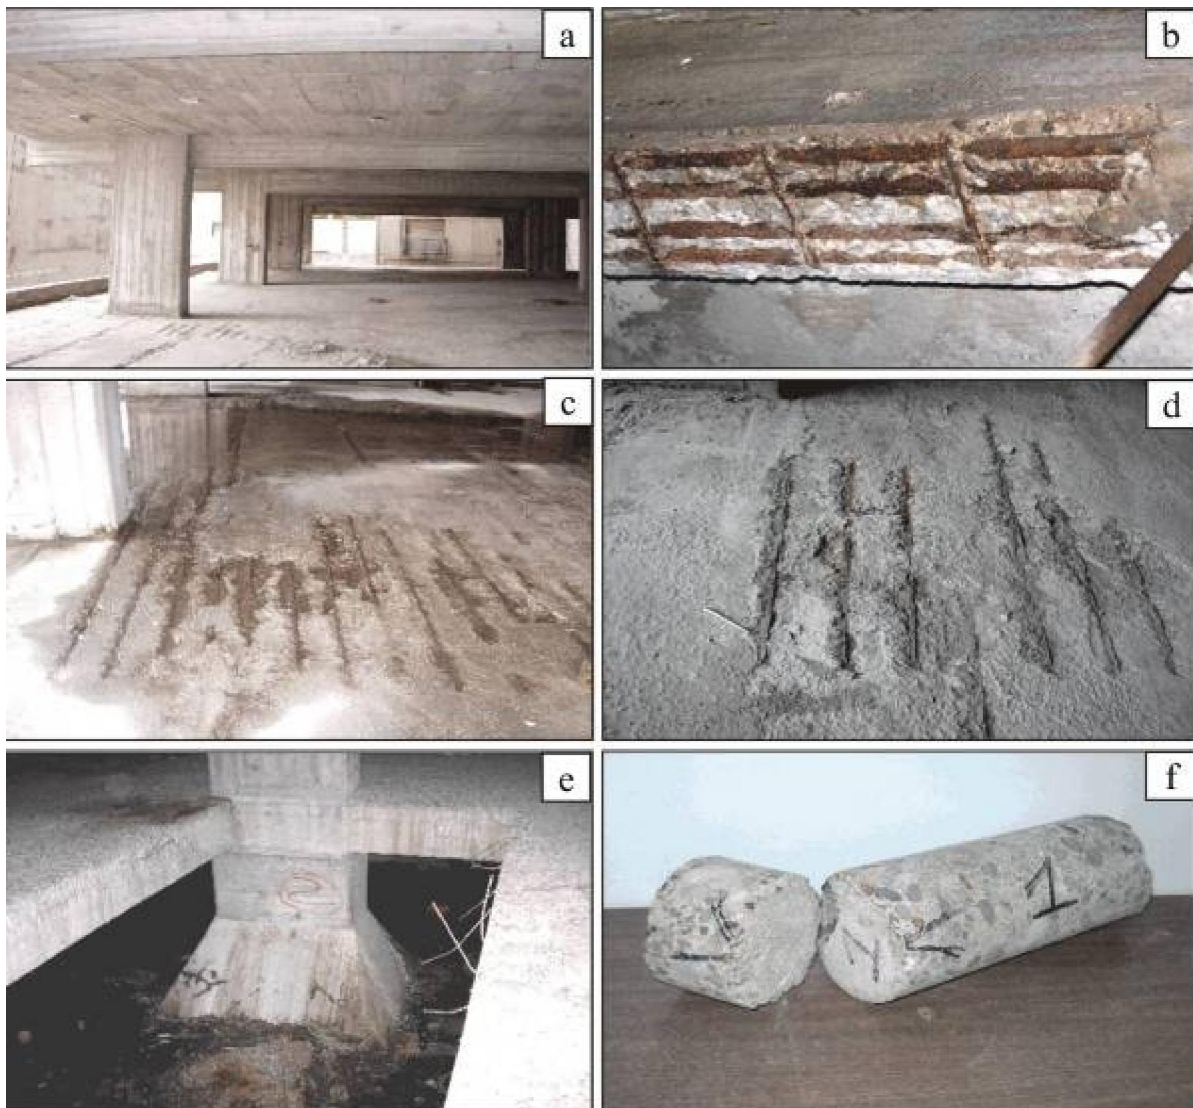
Relevamiento de la estructura emplazada en ambiente urbano
